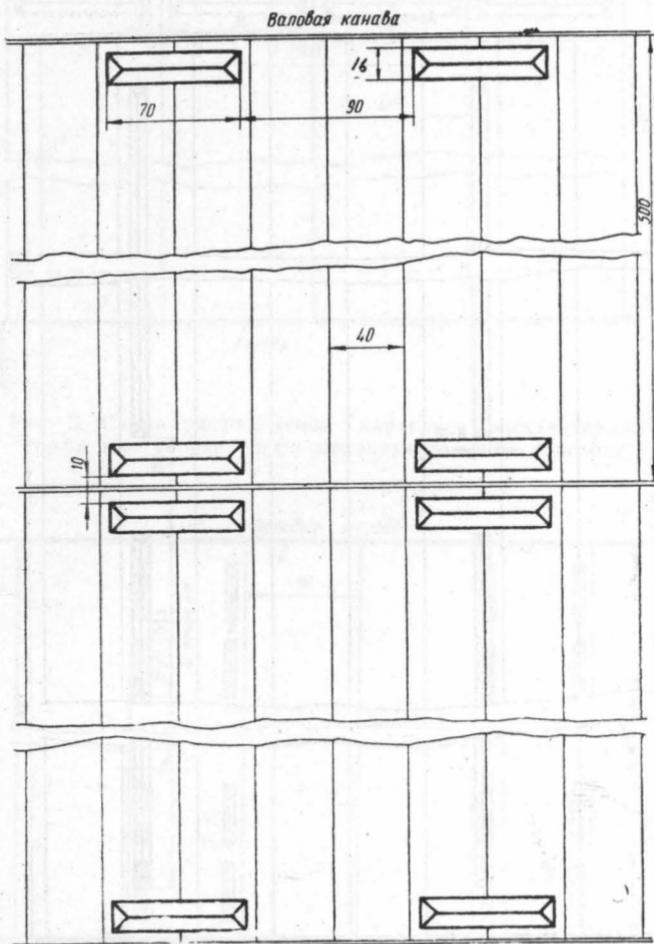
Схема расположения караванов фрезерного торфа при уборке торфа кузовными машинами.
